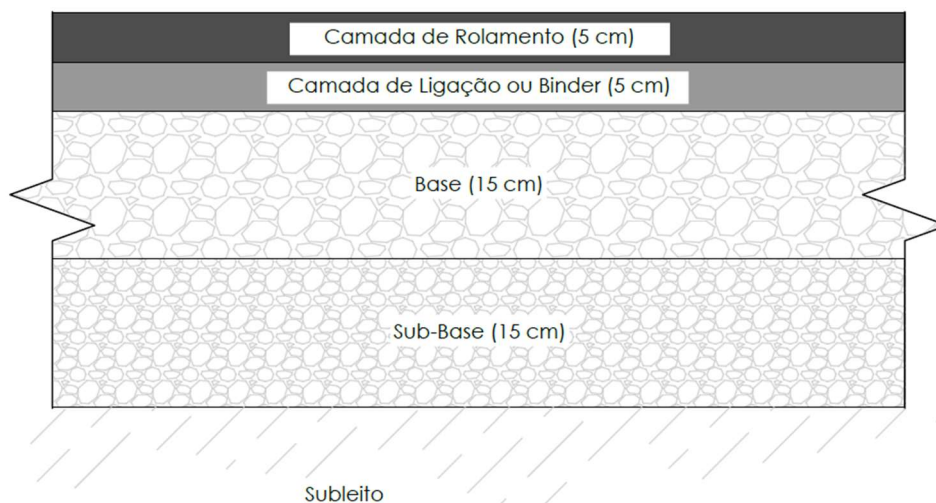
Seção transversal da obra da galeria com recomposição de pavimento
